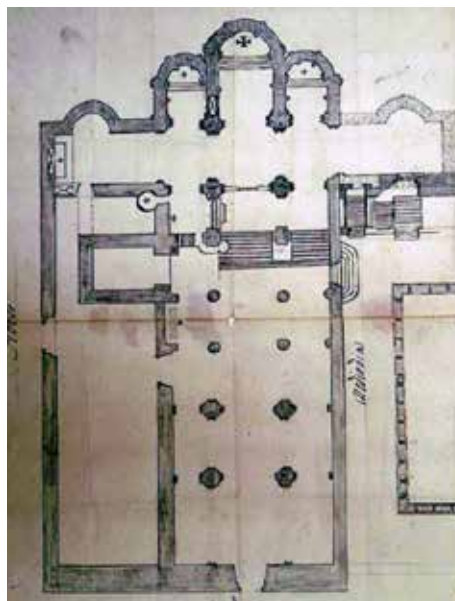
Plano atribuido a Rodrigo Echevarría (Siglo XVIII)
